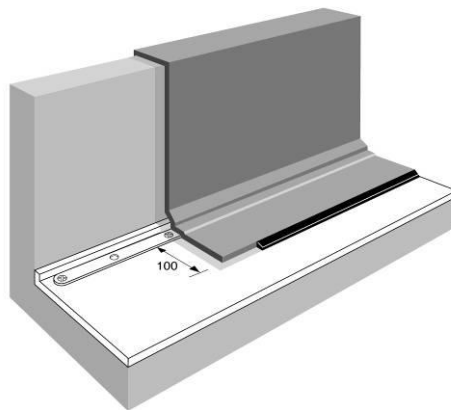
Fixation d'embase par latte d'ancrage sur la membrane, recouvrement à la colle Splice Adhesive.
